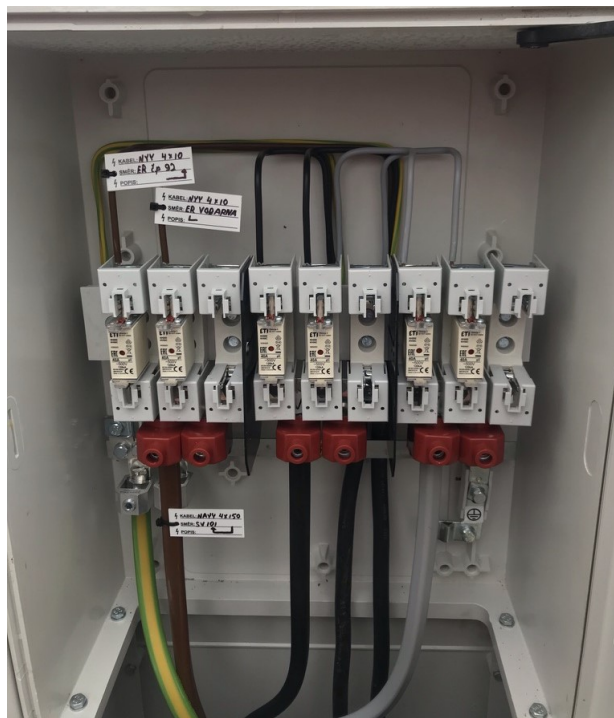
Rozpojovací pilíř SR522, [Zdroj: Archiv autora]
